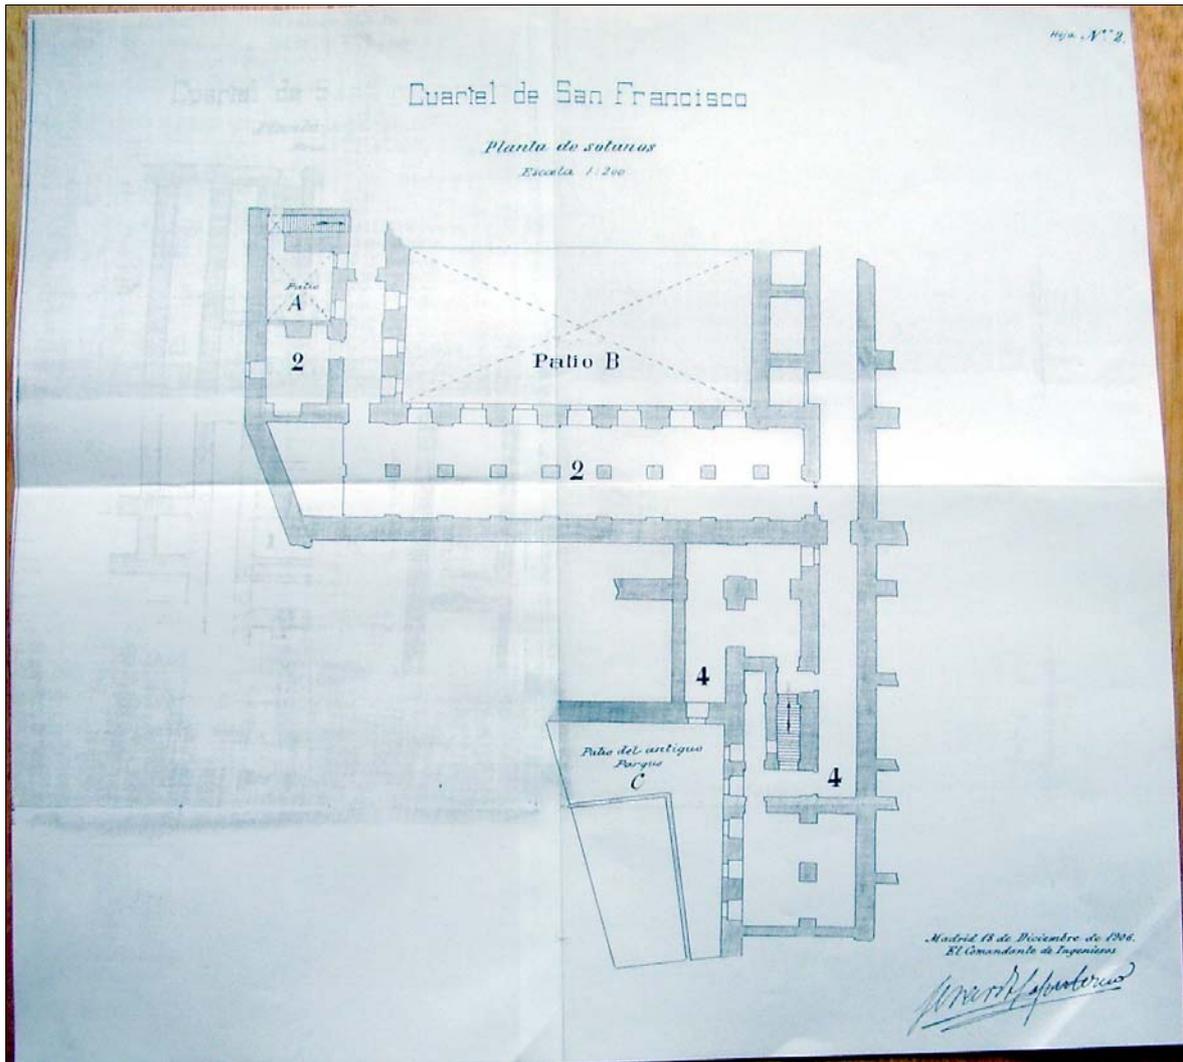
Cuartel de San Francisco. Levantamiento planimétrico del nivel de sótanos de la zona del Patio de Arapiles. Escala original, 1:200. Archivo General Militar, Sección 3ª., división 3ª., leg. 580.
